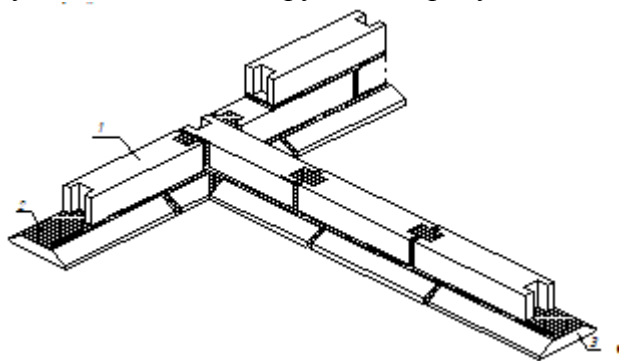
Вариант сборного ленточного фундамента: 1-фундаментный блок, ФБС; 2-цементно-песчаный раствор; 3-фундаментная подушка, ФЛ.
